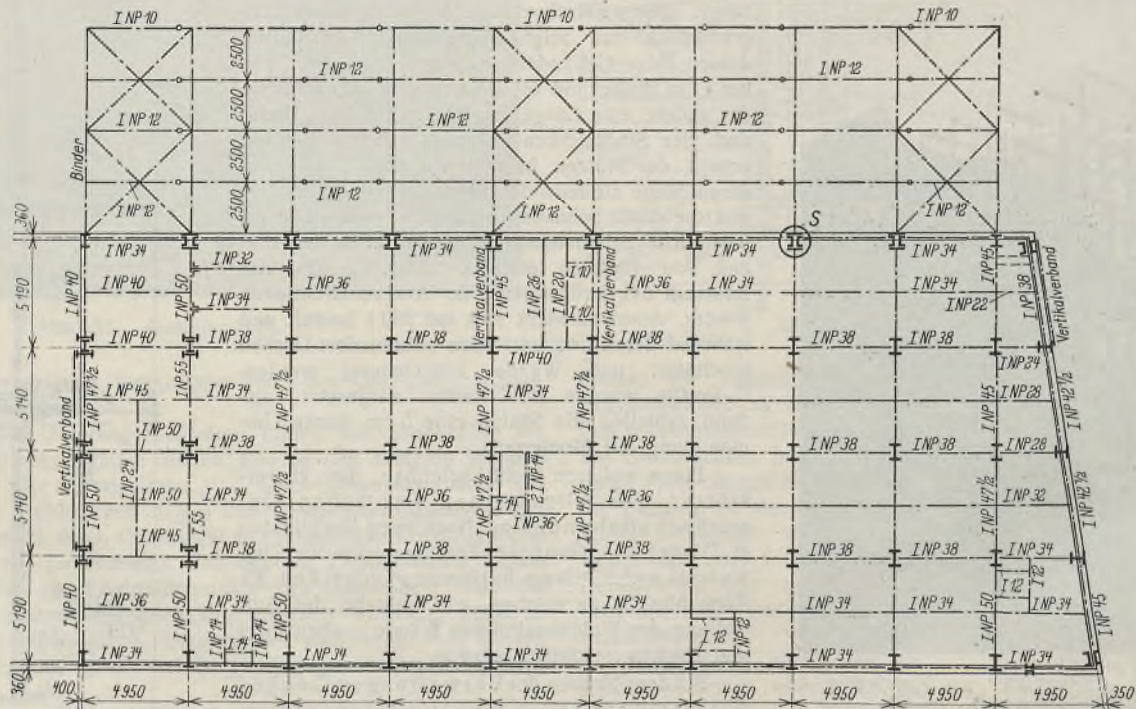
Grundriß mit Stützenstellung und Trägerlage.
